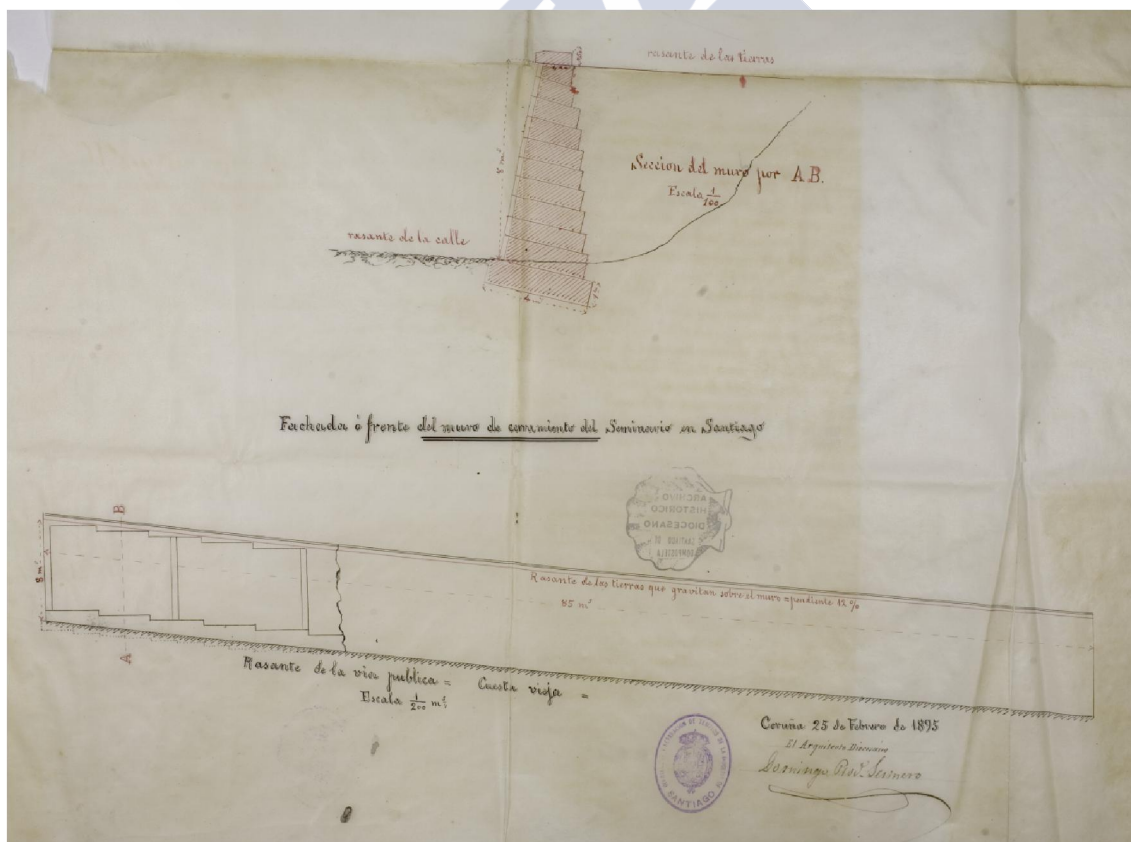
Plano de la muralla de cierre de la Huerta de San Martiño 1895. A.H.D.S. Fondo General 474. Subcarpeta 7ª "Seminario obras 1893-1900".
